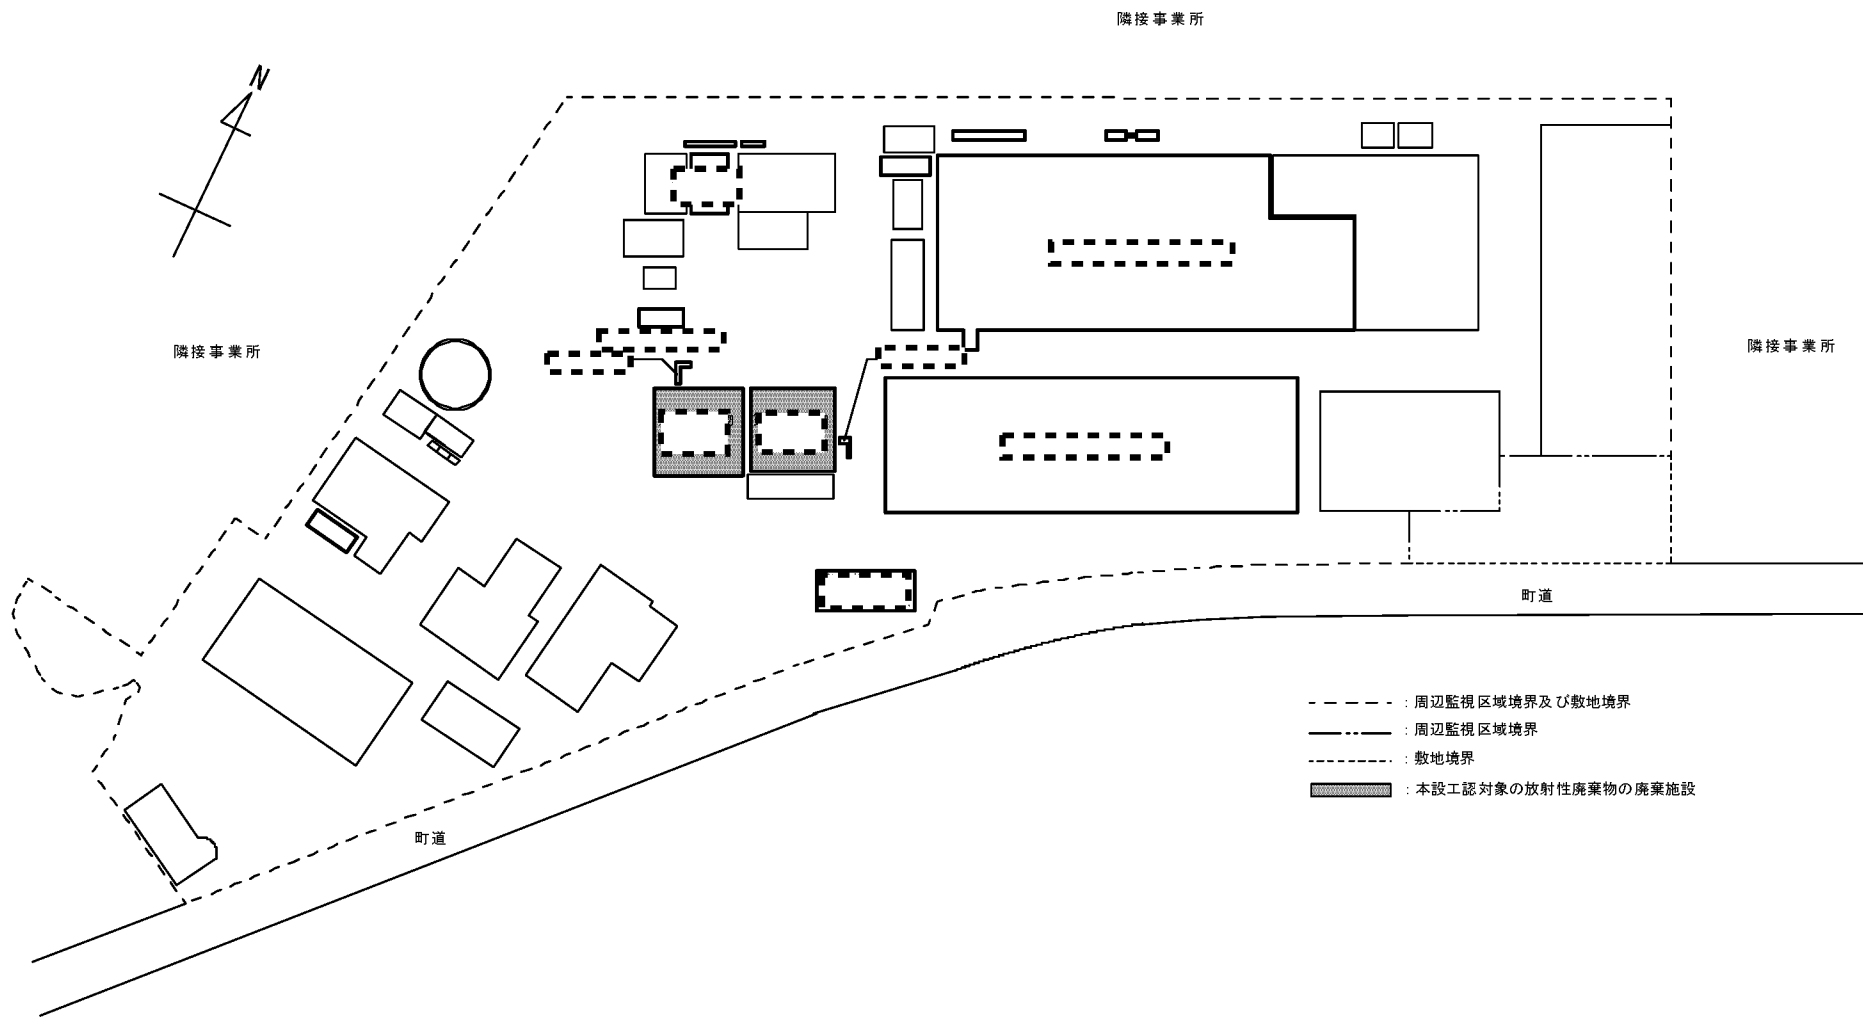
P設-7 (1) 第2 廃液処理設備 及び 第2 廃液処理設備貯留設備 配置図
